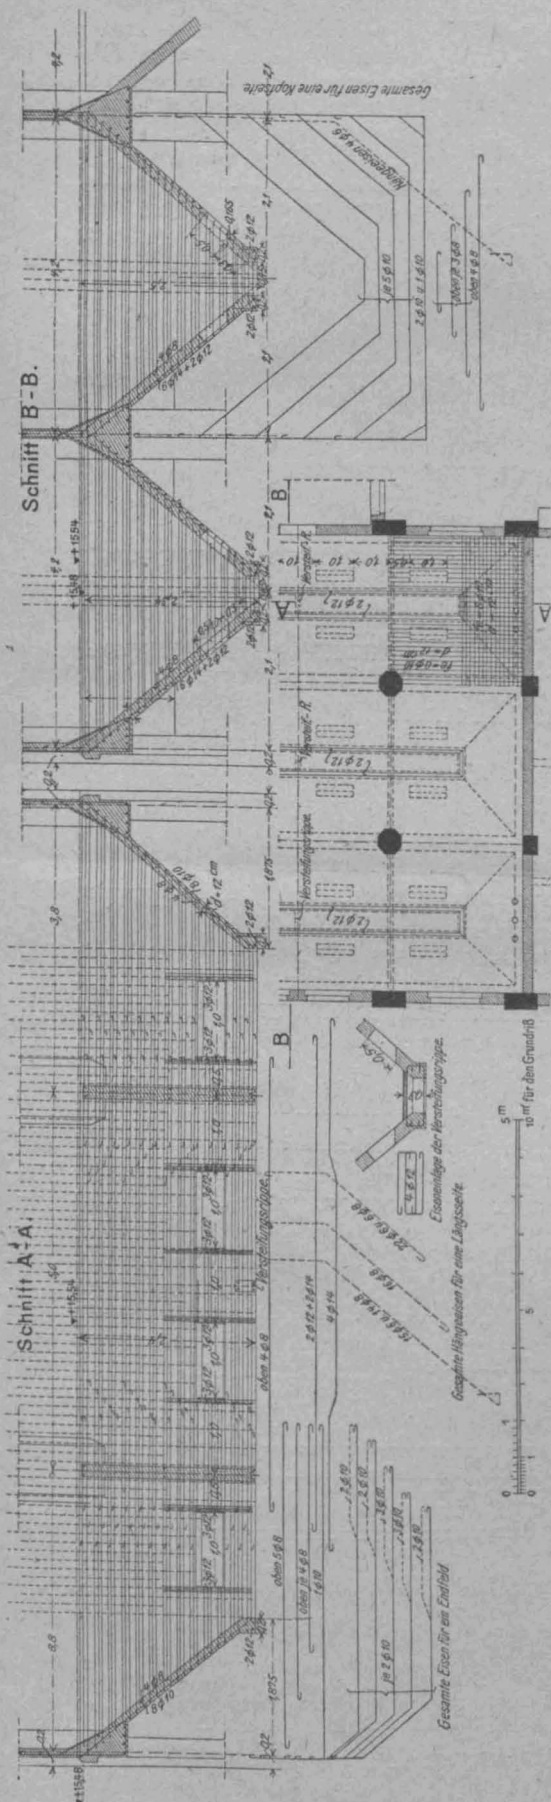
Bewehrung des Silobodens und des Auslaufes im Grundriß und lotrechten Schnitten.
